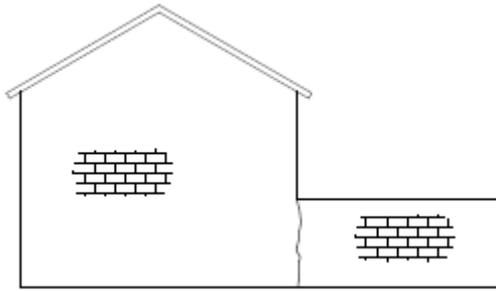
Fissuras em alvenarias por acúmulo de tensões
